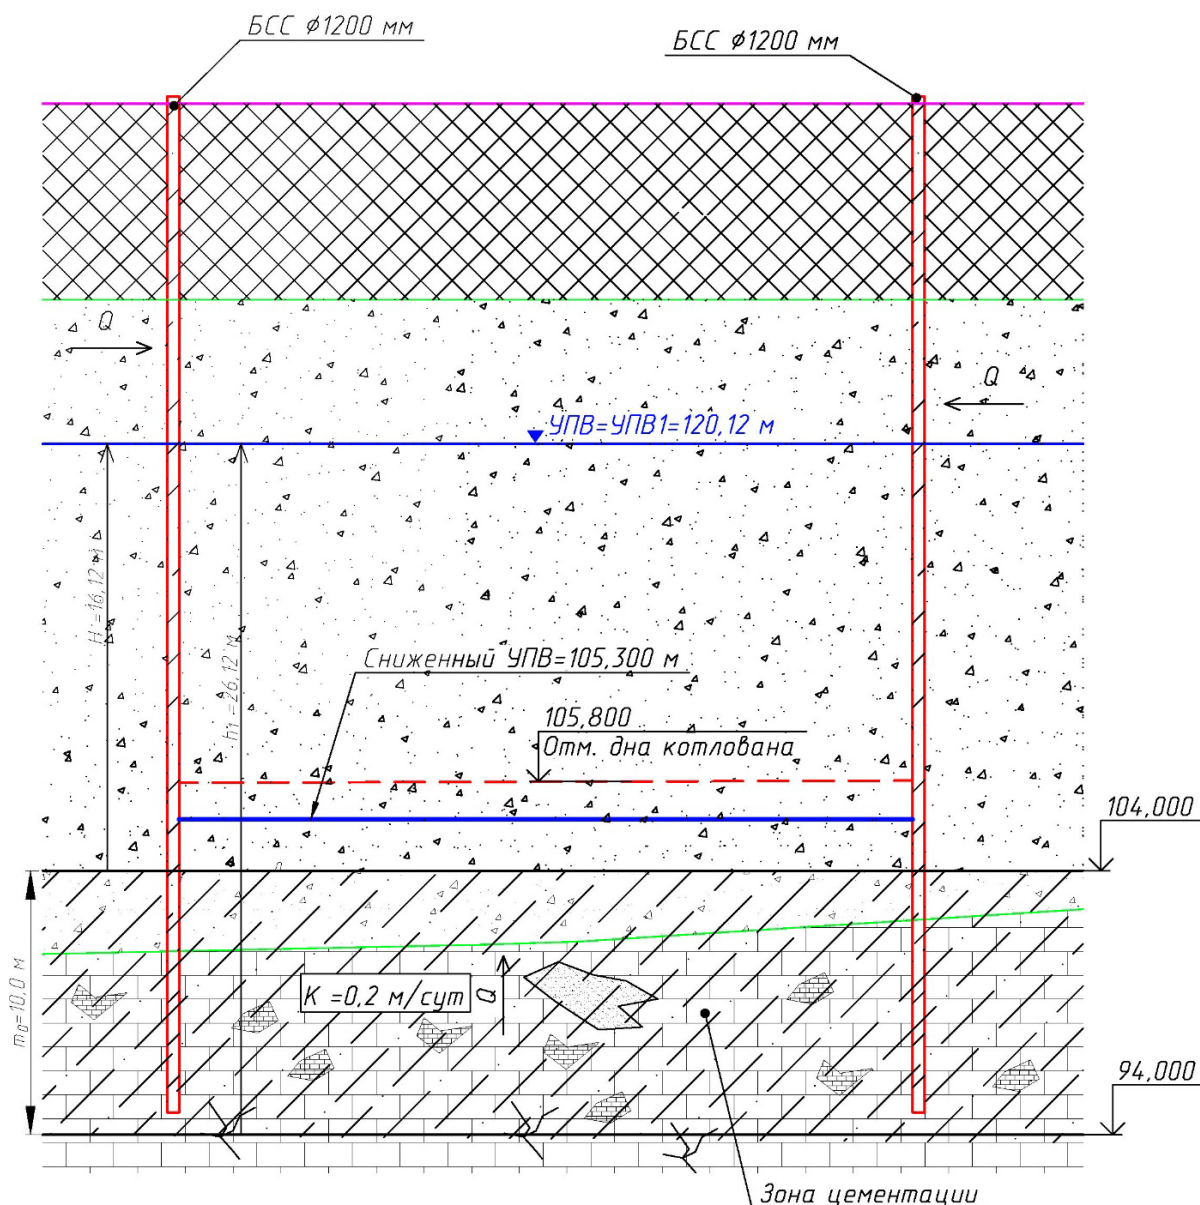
Расчетная гидрогеологическая схема для определения водоприток в котлован в зоне эрозионного вреза
